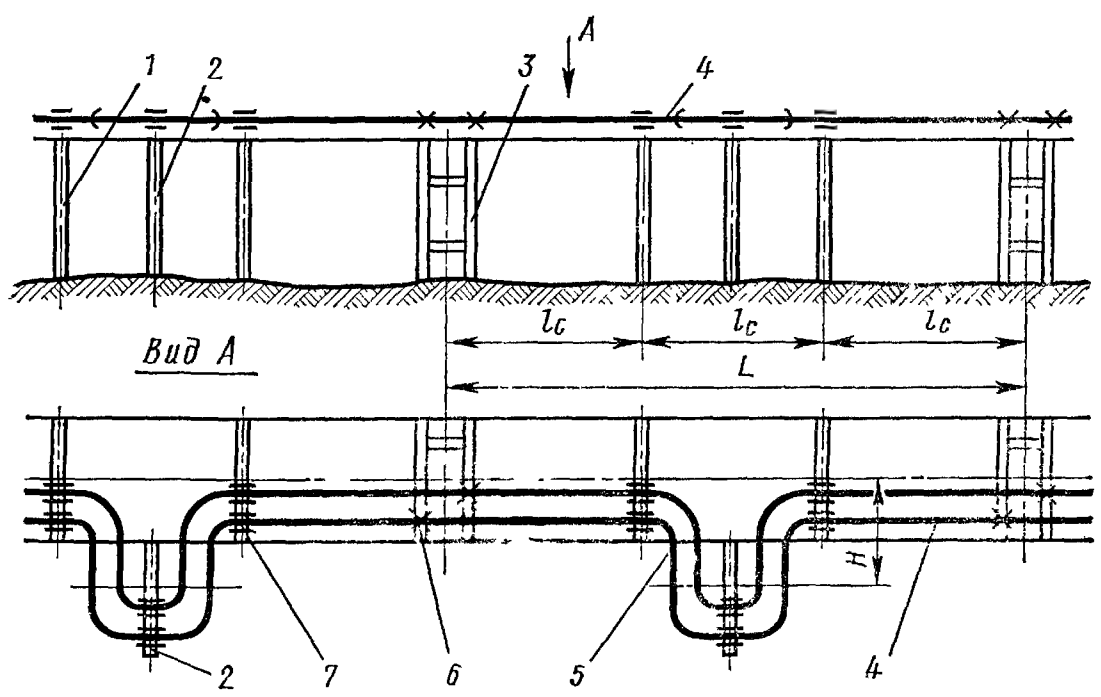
Прокладка трубопроводов большого диаметра на высских стойках:
